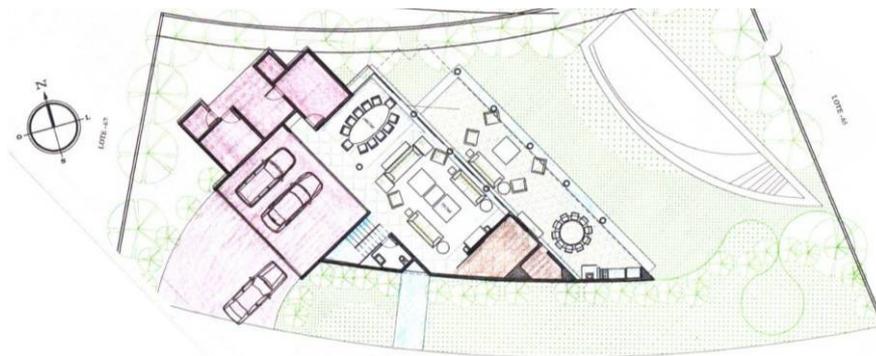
Planta baixa do pavimento térreo (estudo 01)
